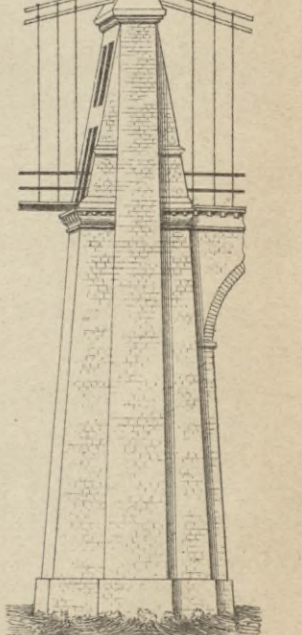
Portal der Wittelsbachbrücke in München. M. 1:100.
